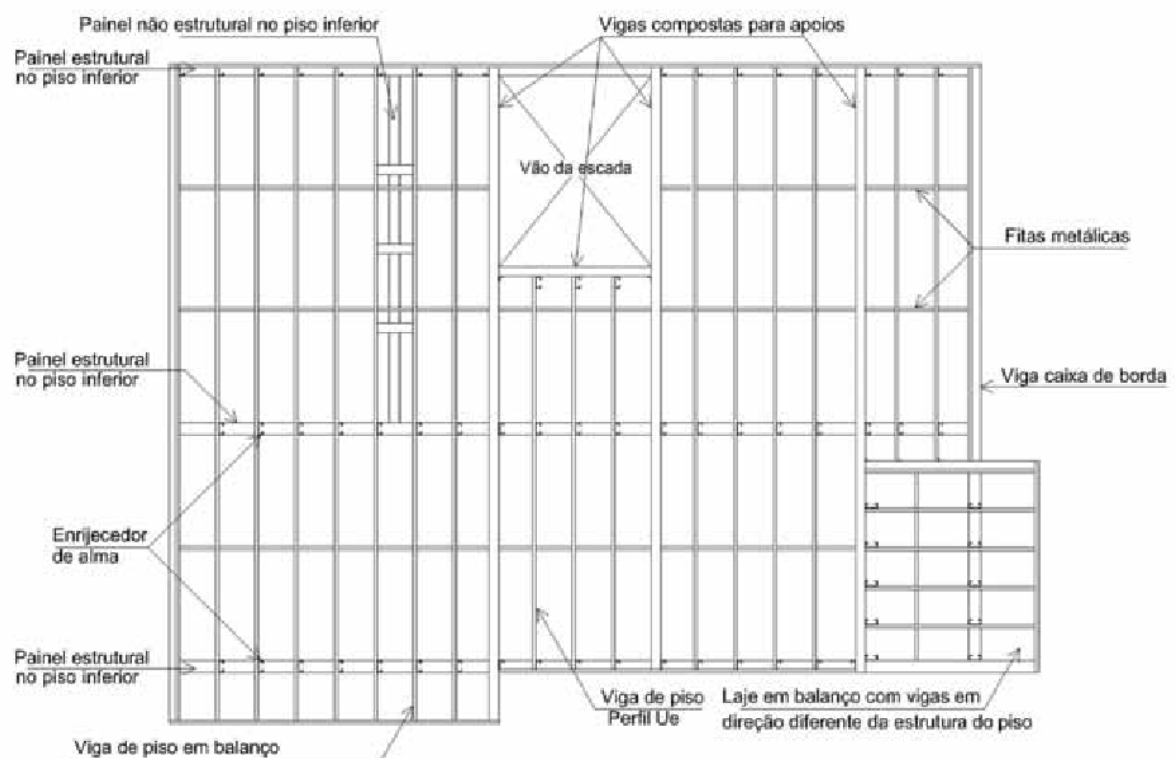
Planta de estrutura de piso em Light Steel Framing
